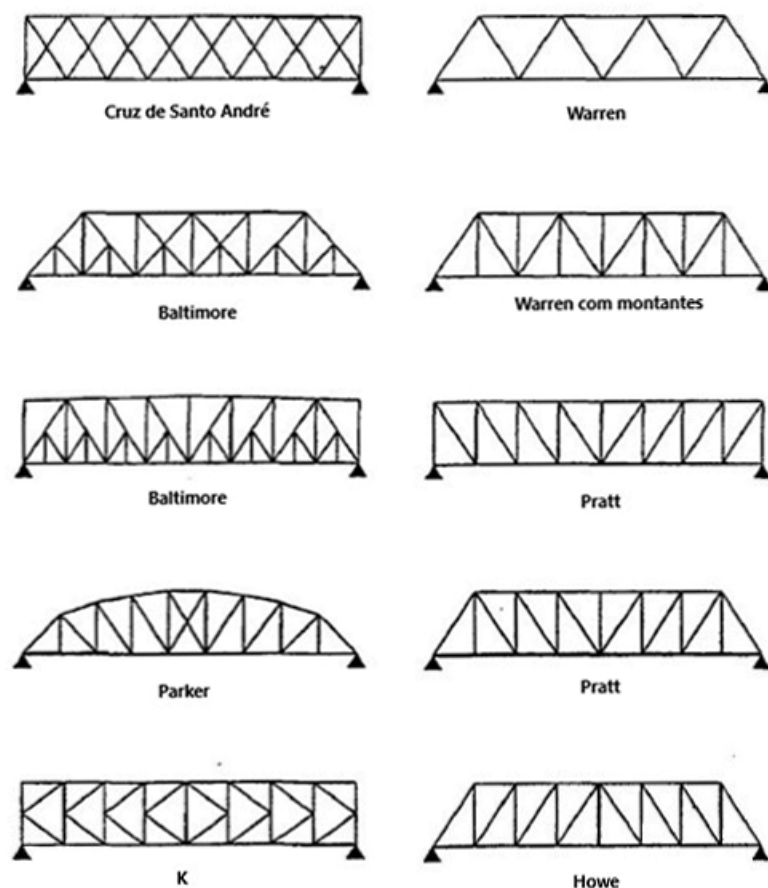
Vigas tipo em treliça para pontes metálicas, adaptado de [17]
